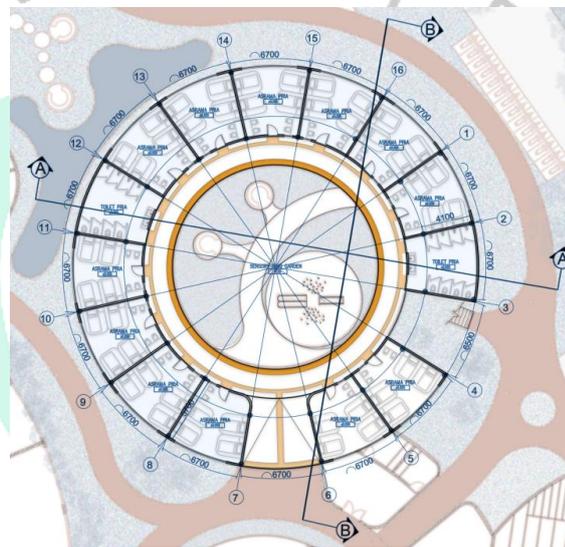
6 Denah Lt. 1 SDLB
